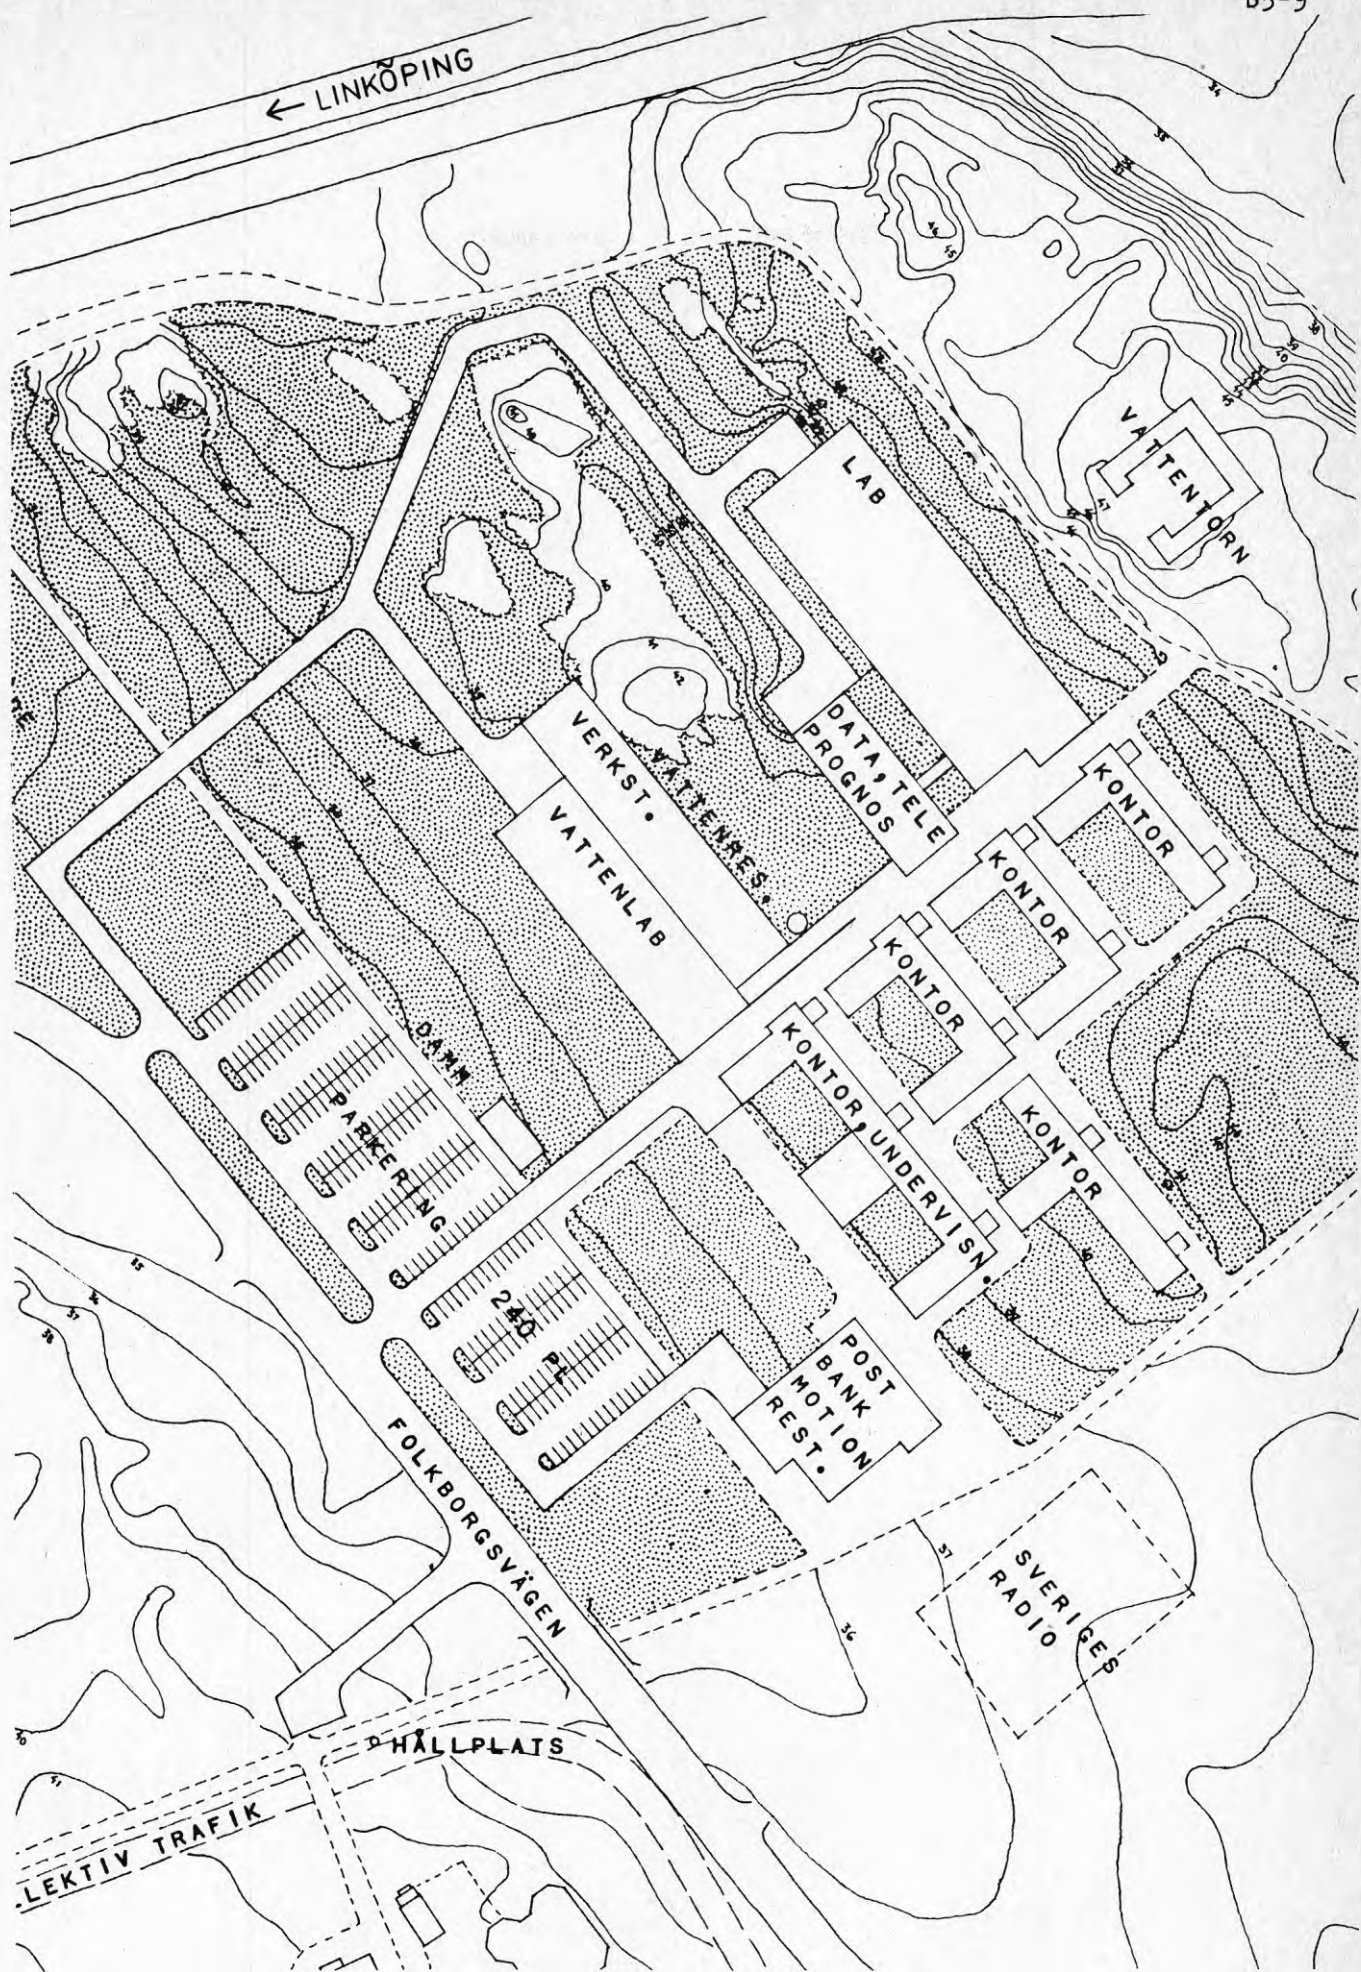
Situationsplan till systemskiss 1972-01-15
